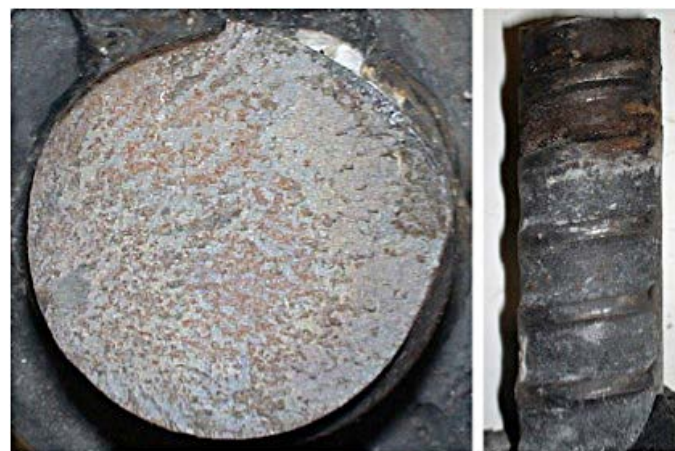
Aspeto geral duma superfície de fratura e pormenor da corrosão na superfície da barra de aço.
